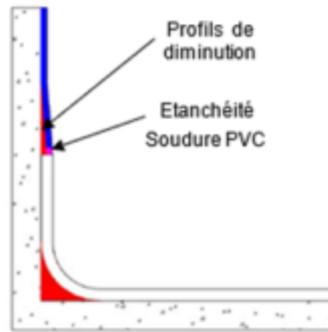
Remontée en plinthe sur sol PVC : soudage/joint avec profil de diminution ou enduit (uniquement pièces sèches)
